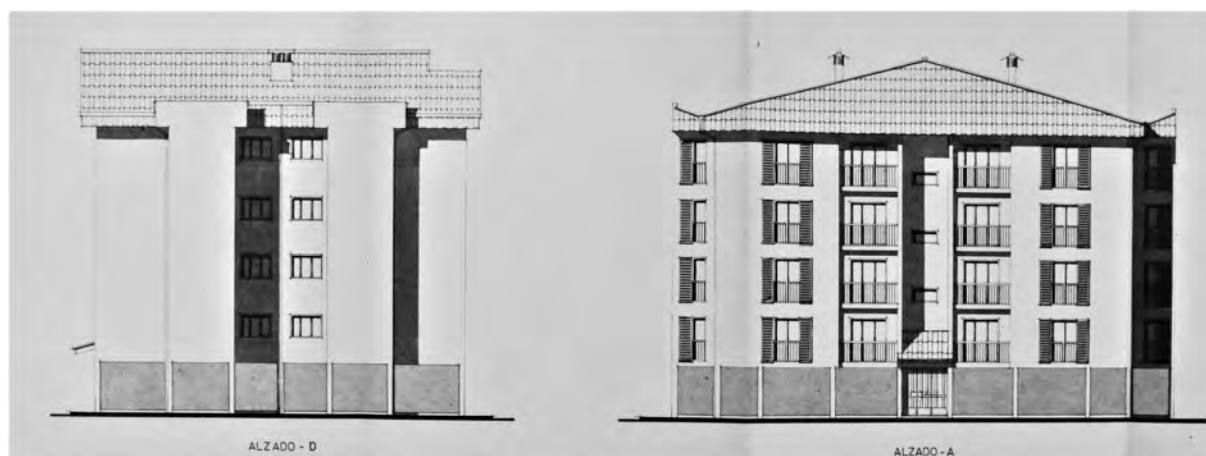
Grupo de 232 viviendas sociales Barrio de San Fernando. Diseño de uno de los bloques de cinco plantas situado en la plaza central. (A.M.L.)
